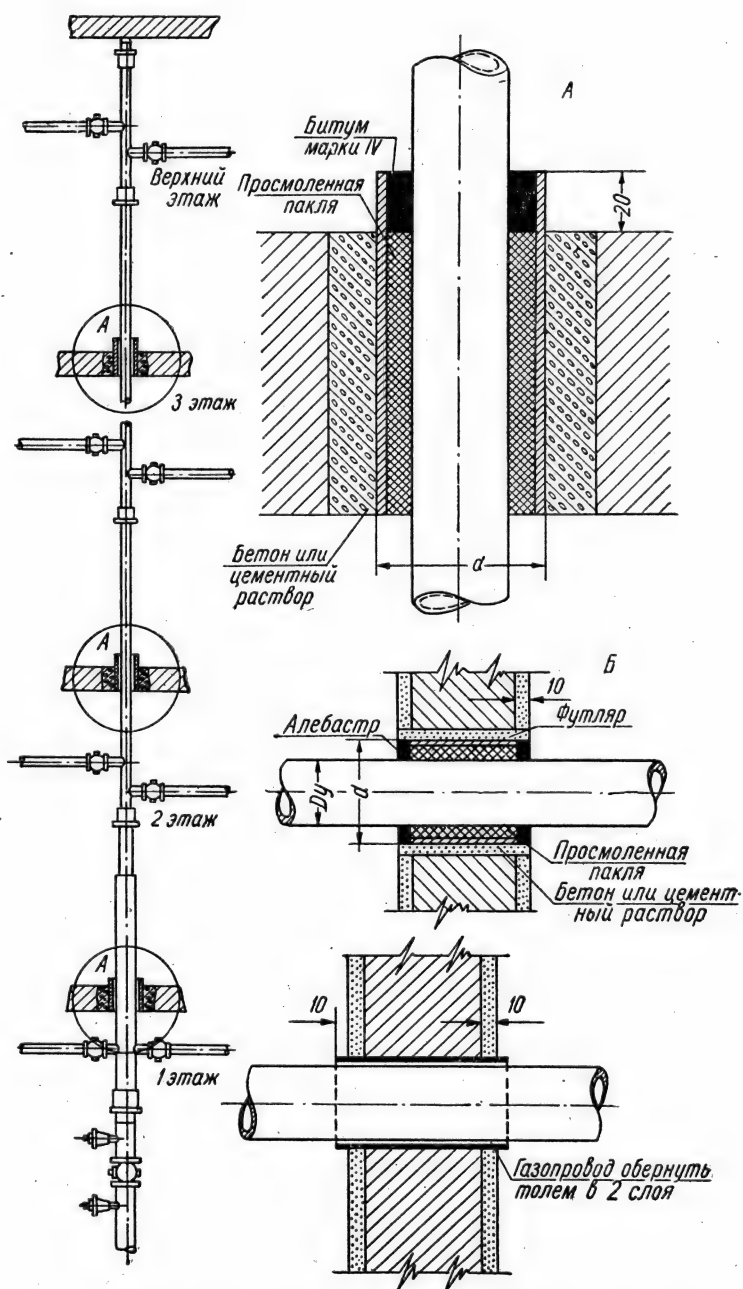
Лестничный стояк с двухсторонними отводами в квартиры: А — проход газопровода через лестничную площадку; Б — проход газопровода через стены из пустотелого кирпича, шлакобетона и засыпные; В — проход газопровода через деревянные оштукатуренные, каменные и железобетонные стены.
